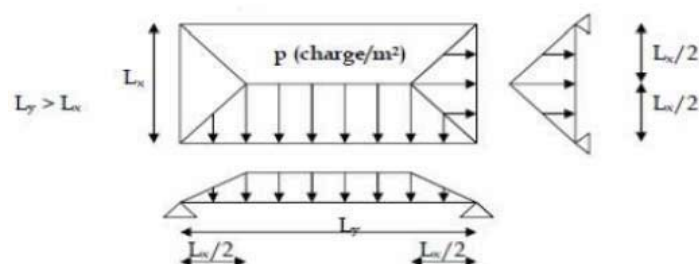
La répartition des charges sur une dalle portée par 4 poutres.
